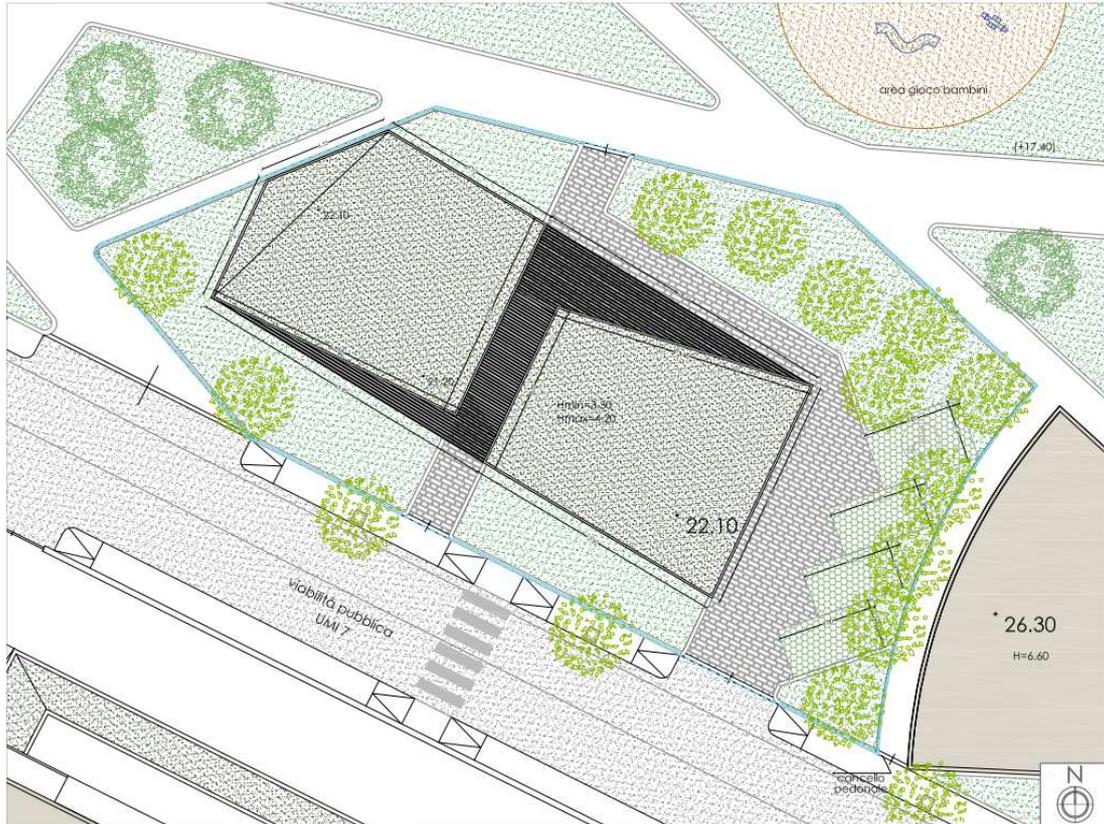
stralcio planimetrico del centro di aggregazione sociale
